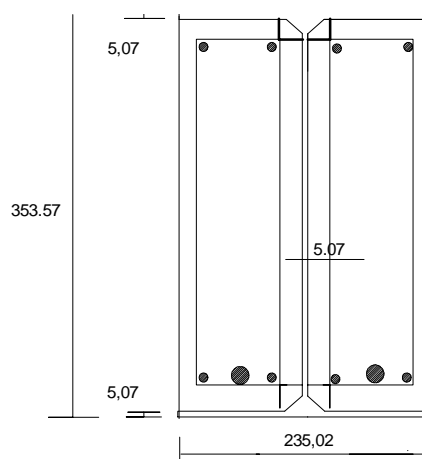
Seção Transversal da Viga VS2 (dimensões em mm)
